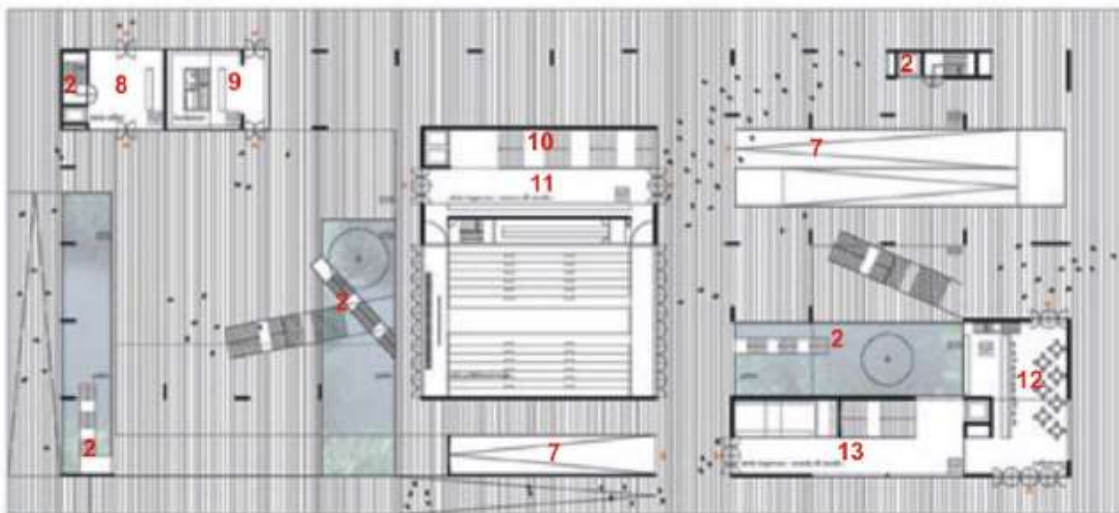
Planta térrea, pátio publico (fonte: jlcg arquitetos)
